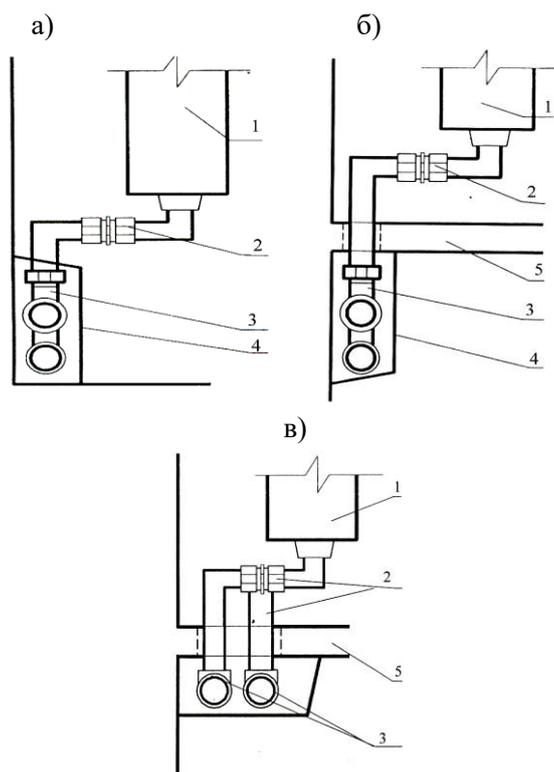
Схемы подключения отопительного прибора: а) разводка над полом; б) разводка под перекрытием с горизонтальным расположением пары трубопроводов; в) разводка под перекрытием с вертикальным расположением пары трубопроводов. 1) отопительный прибор, 2) подключение отопительного прибора, 3) тройники, 4) плинтус, 5) плита перекрытия.
